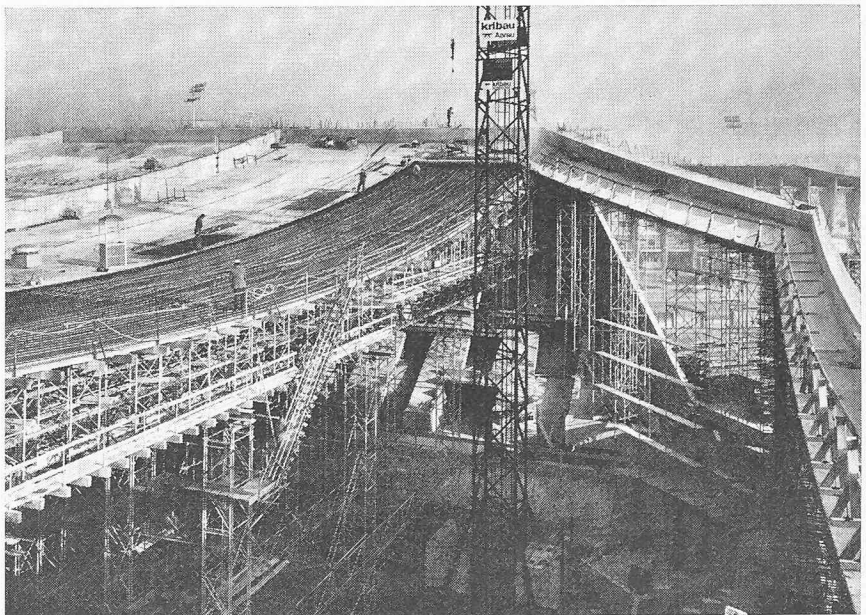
Bauvorgang Hängedach: Betonieretappe von 10 m Breite des Hängedaches aus Leca-Beton, auf einem verschiebbaren Gerüst eingeschalt. Rechts im Bild der aus herkömmlichem Beton vorweg erstellte Dachkranz, links oben der in Dachmitte angeordnete Dilatationsträger
